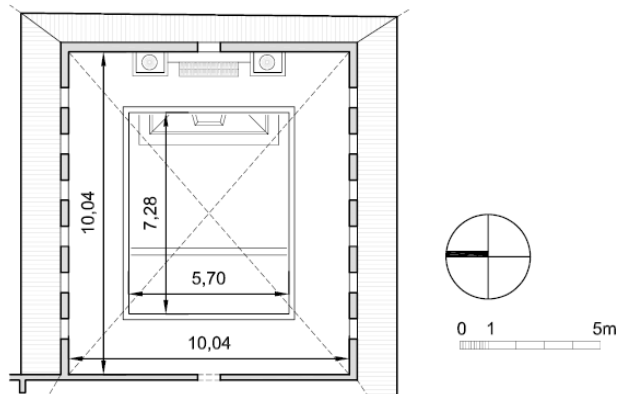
Rekonstruktion, Ausschnitt aus dem Grundriss des Dachgeschosses, in Anlehnung an [Sch 04/1]
